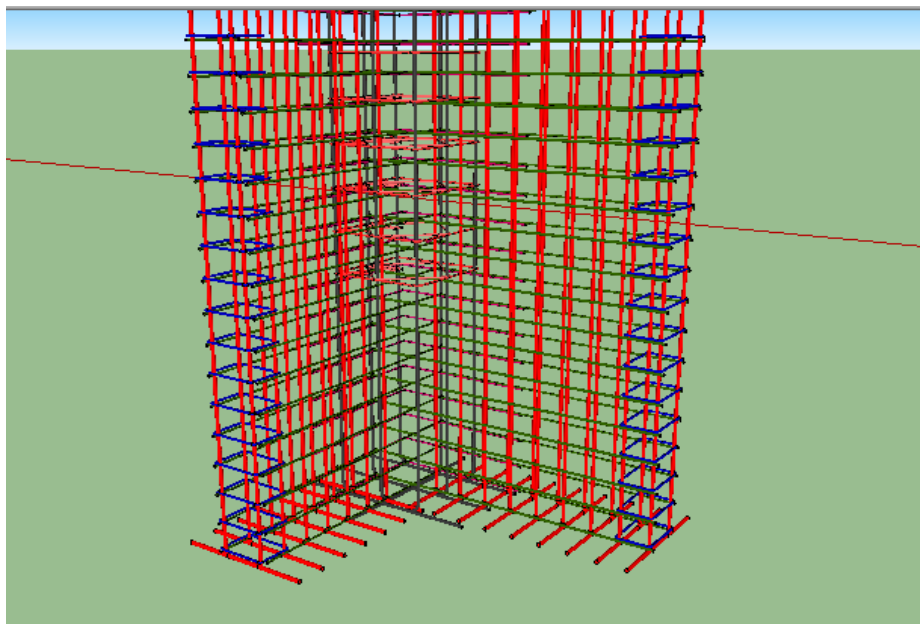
Ferrailage du voile du sous-sol et du noyau central
